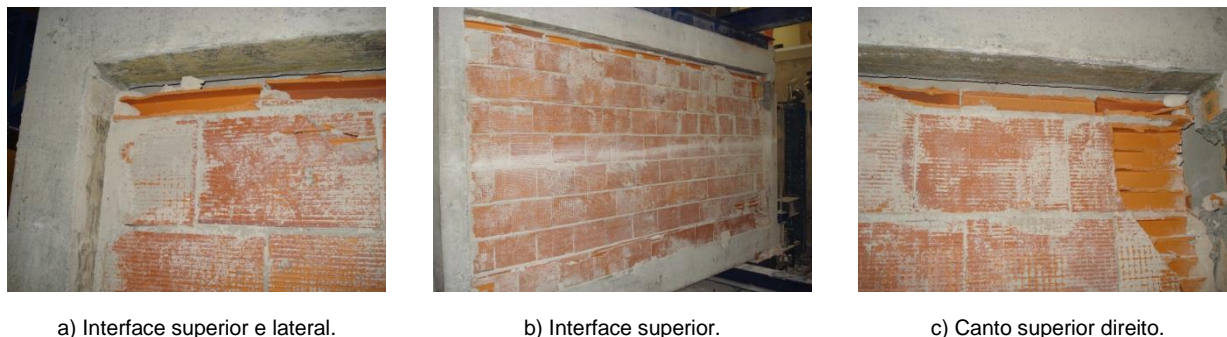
Dano observado na zona superior do painel desconstruído Wall_RAR_01.
